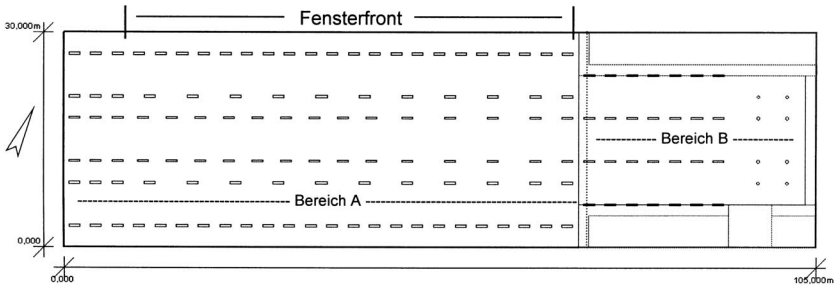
Grundriss der Halle, Bereich A: 2160 m² Grundfläche und 8 m Höhe
